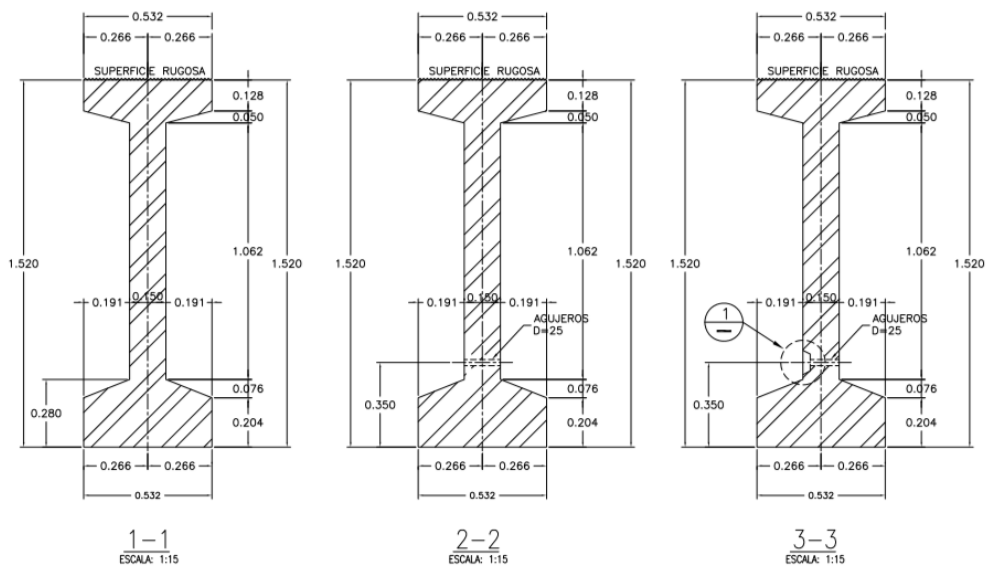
Detalles de Dimensionamiento Vigas Puente WS-100.
